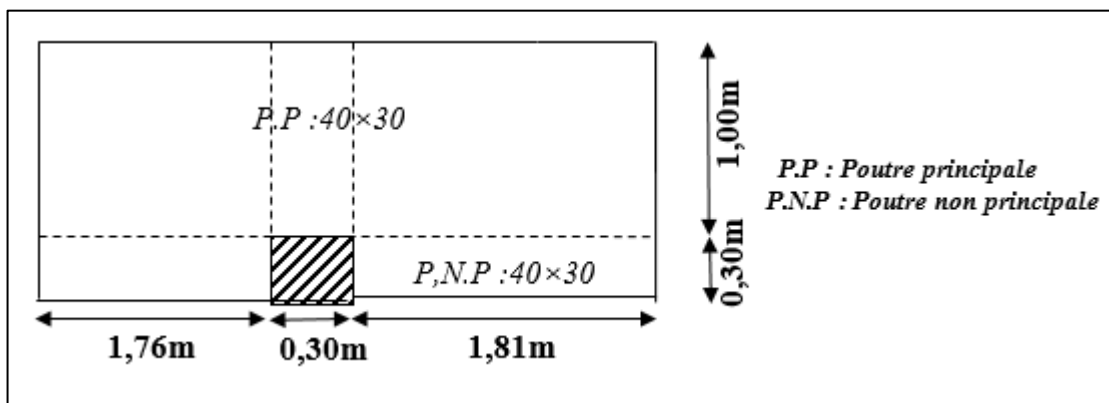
Surface revenant au poteau qui existe dans 2 étages seulement.
